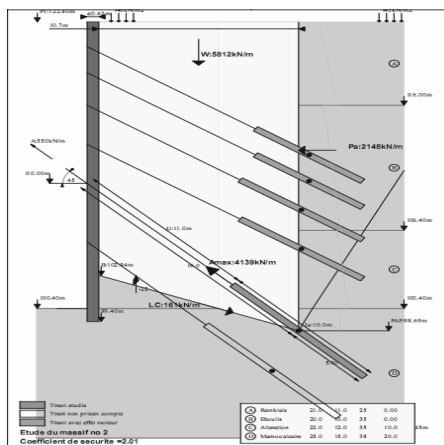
Vérification Kranz – Stabilité du massif d'ancrage
